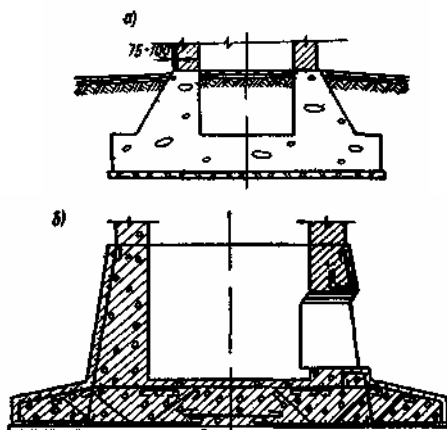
Фундаменти цегельних димарів: *а* – бетонний; *б* – залізобетонний
